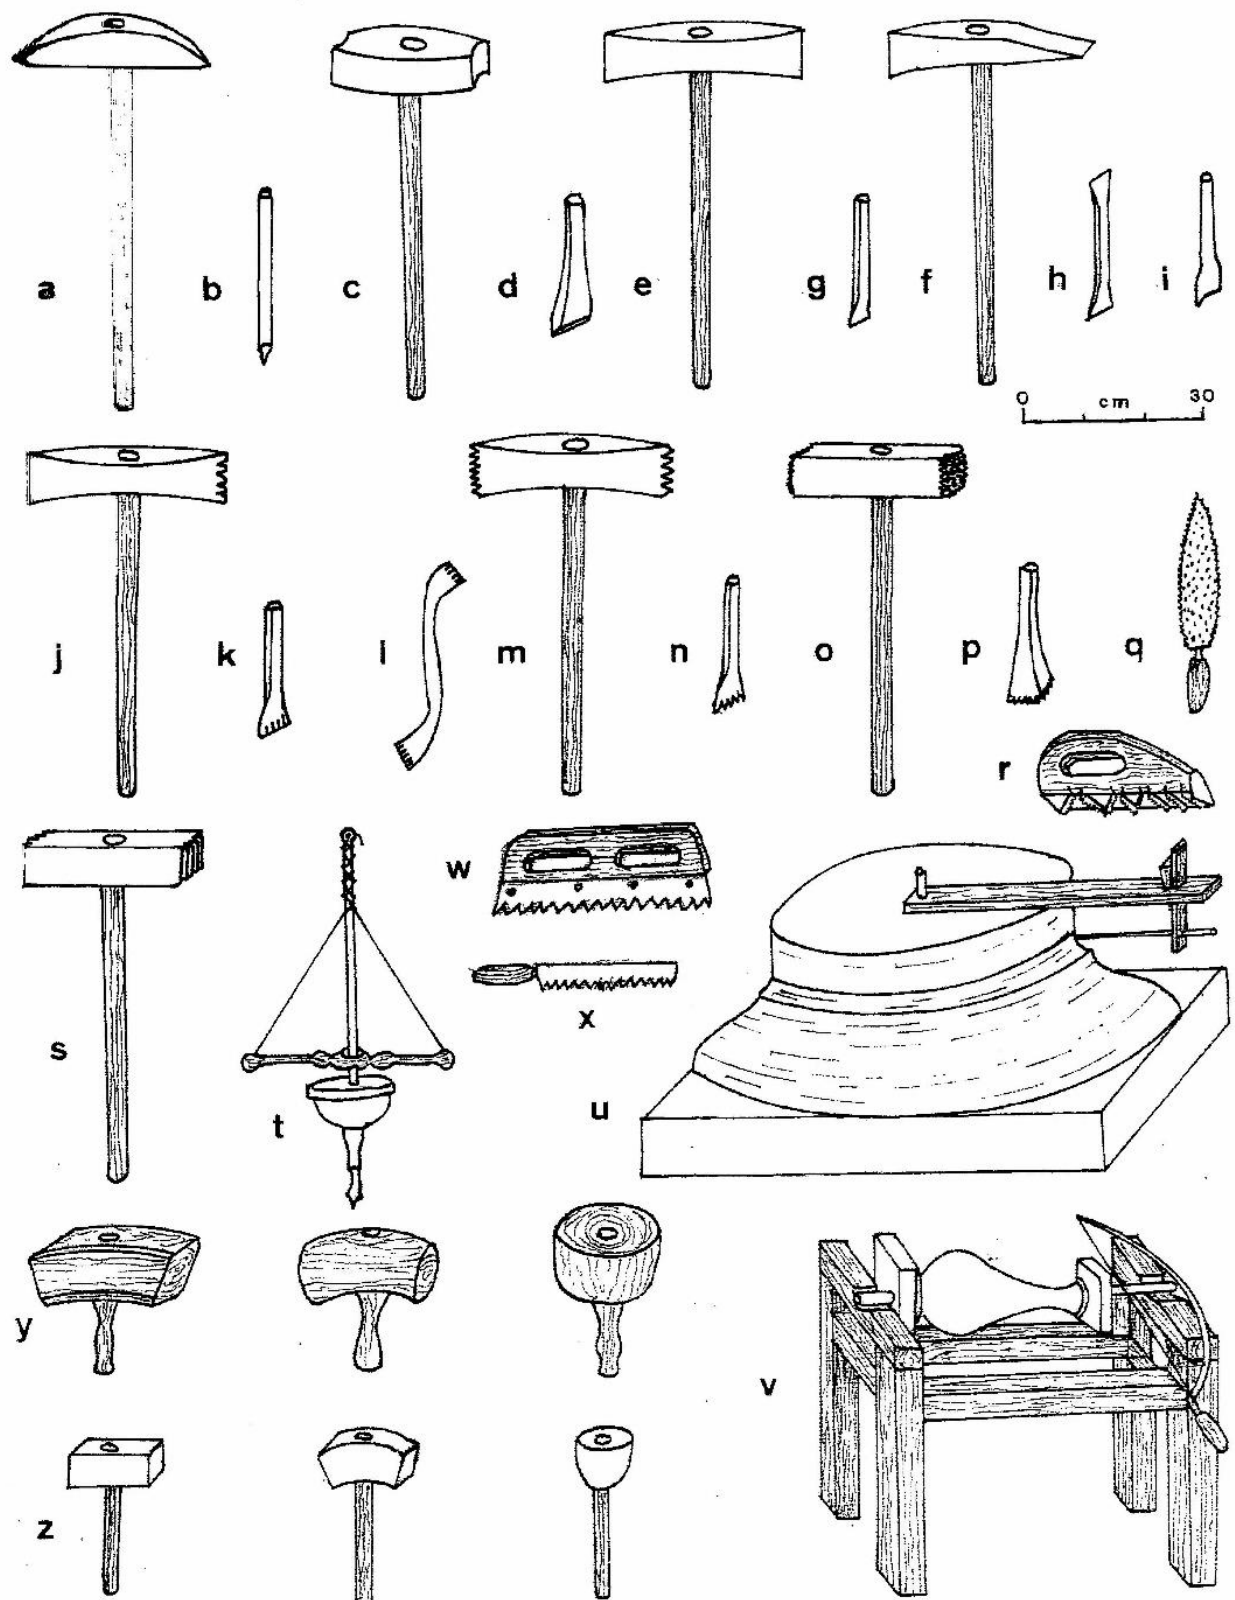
Eines De la talla de la pedra. Extret de: BESSAC, J-C (1999). Pierres de taille: archéologie et technique. En Ferdière, A (dir.) *La construction, Les matériaux durs: pierre et terre cuite*. Paris. Éditions errance. p. 29
